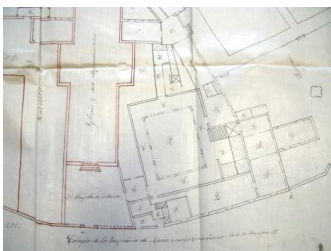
Planta baja del Convento y Colegio de la Enseñanza.
